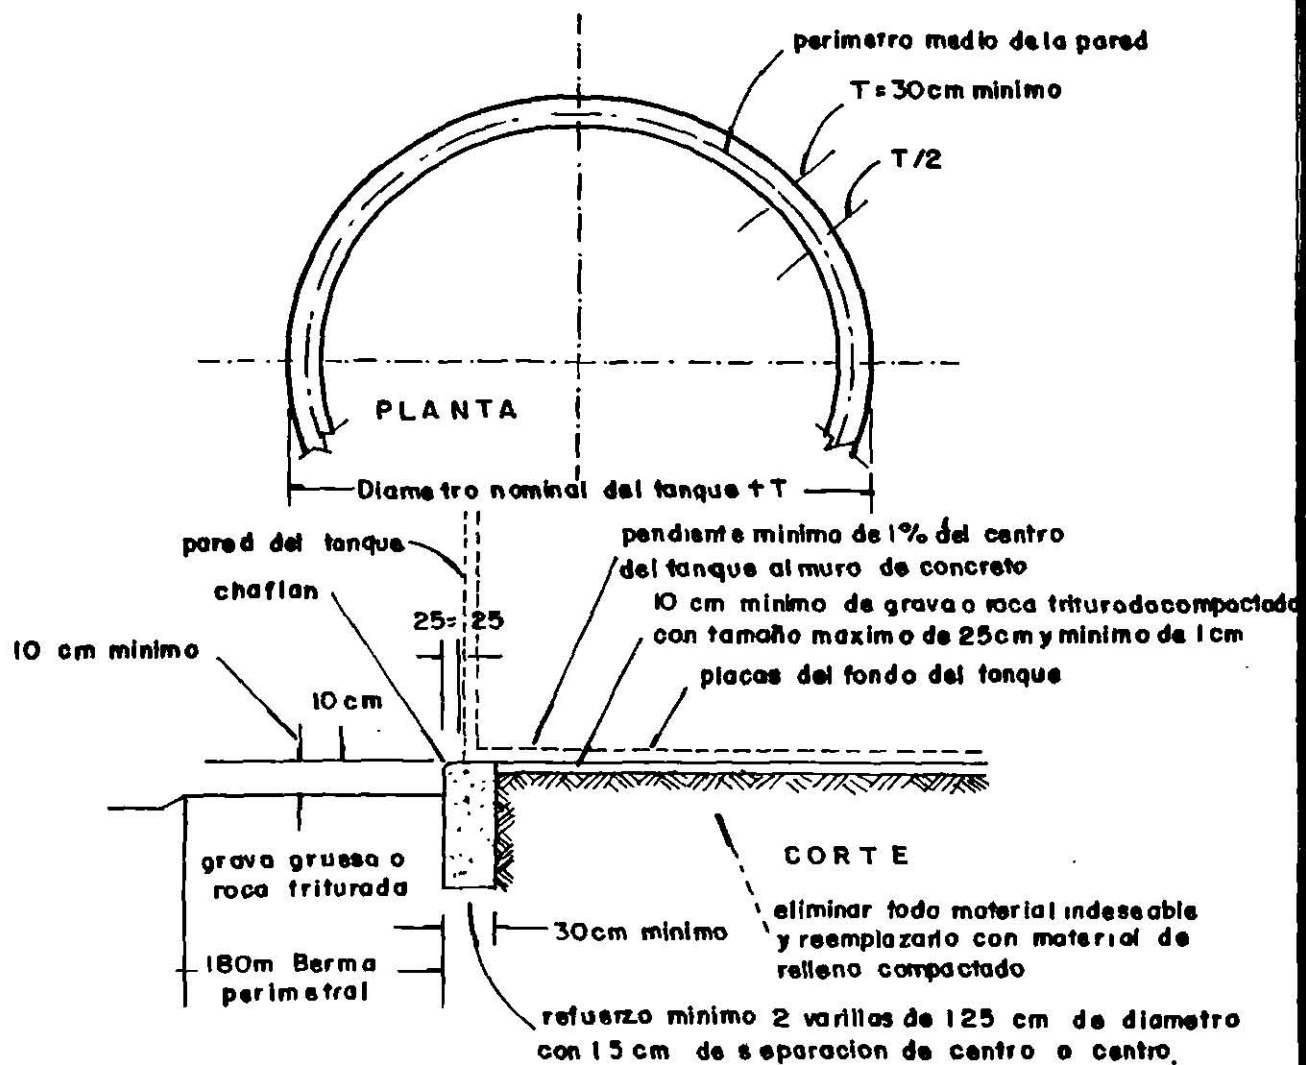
CIMENTACION SOBRE MURO ANULAR DE CONCRETO
